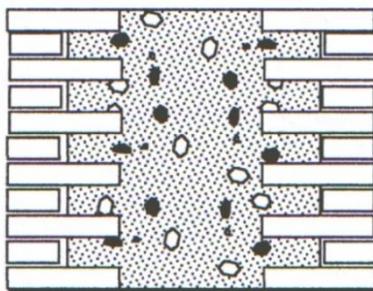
Mur périmétral à double parement simple (technique S'houk).
